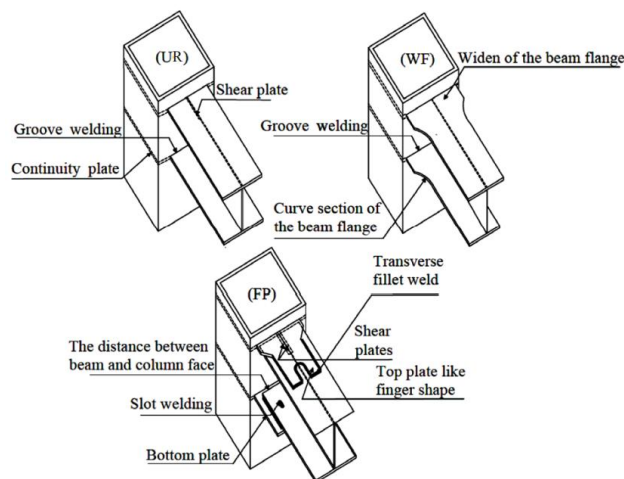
Configuraciones de conexión columna tipo cajón y viga I [27].
